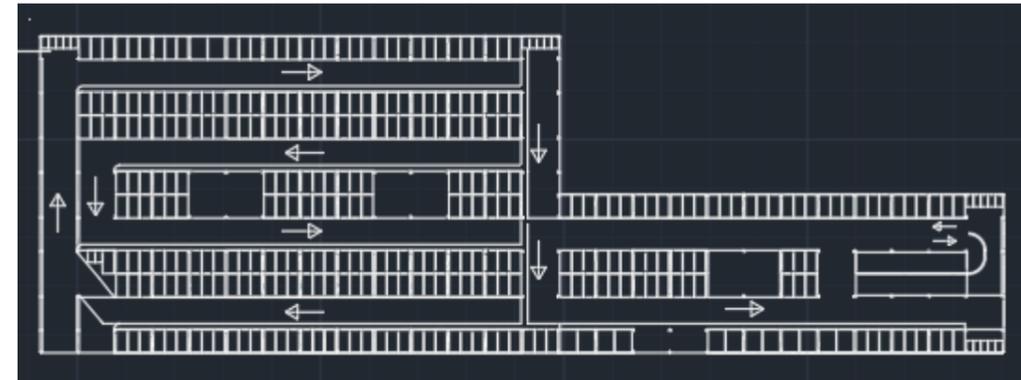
Diseño final planta 1 (forjado 1). Fuente: Elaboración propia
